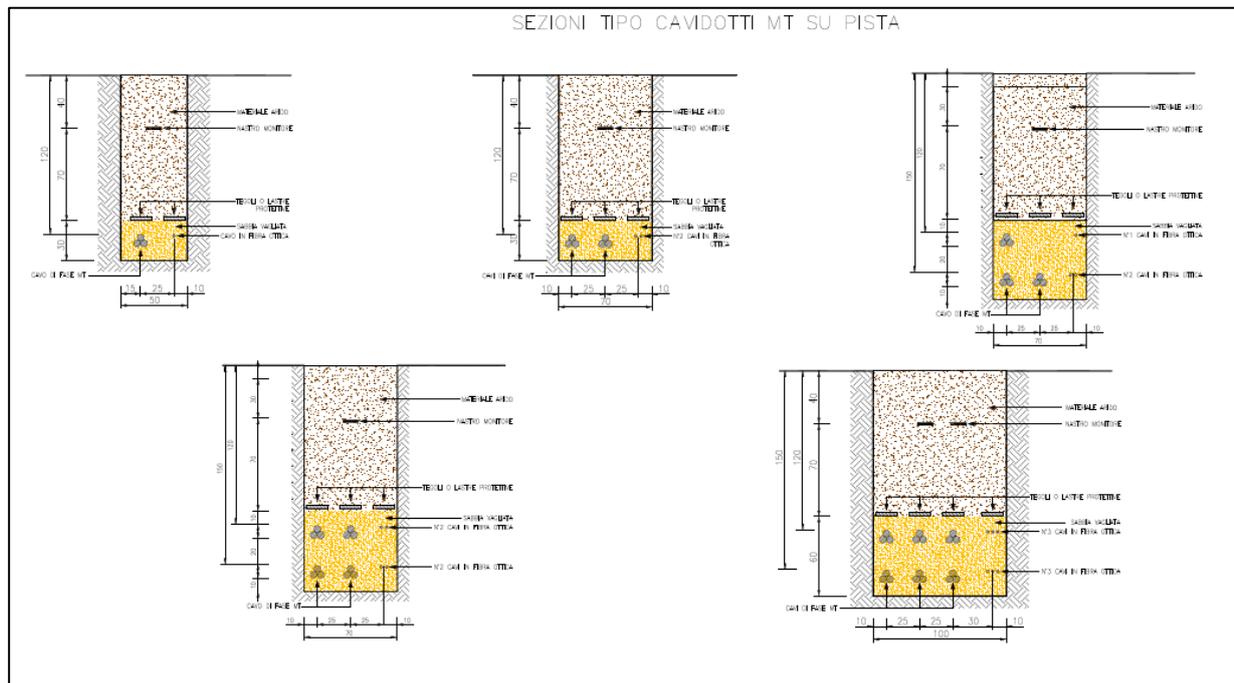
Sezioni tipo Disposizione Cavi MT Su Pista
